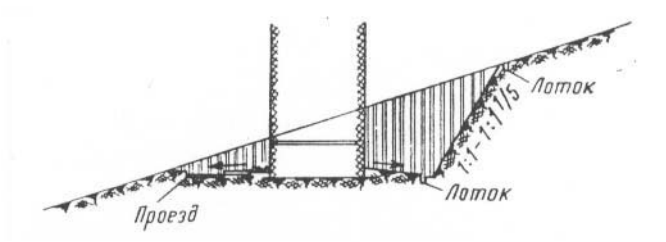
Площадка под здание при крутом поперечном уклоне.
